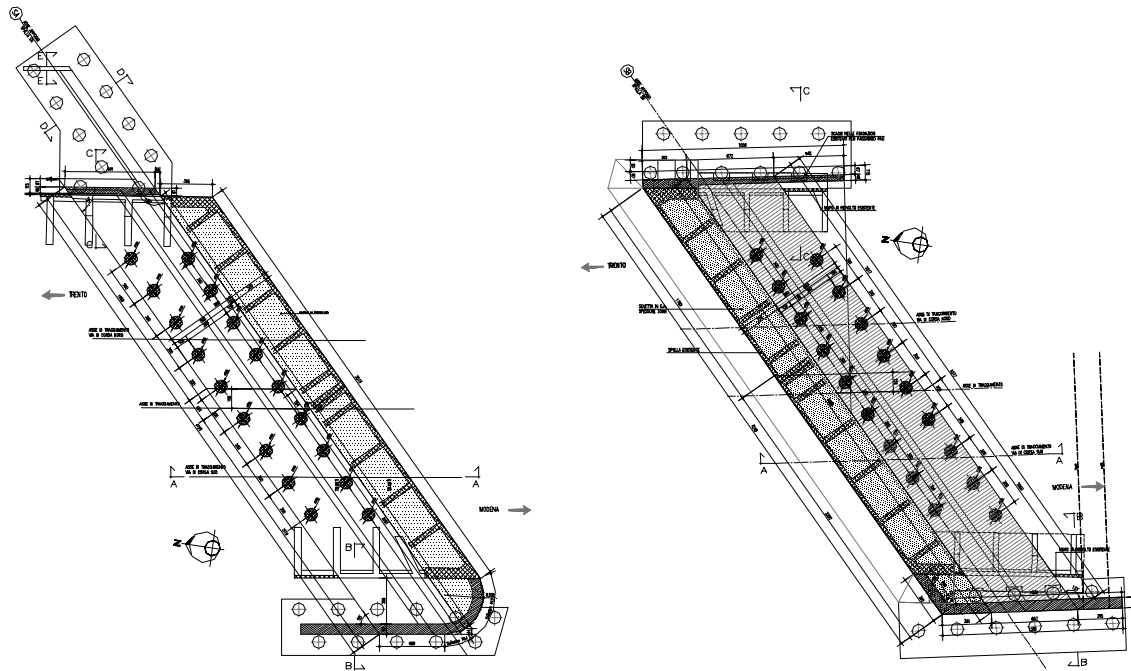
Spalle - Pianta delle fondazioni
